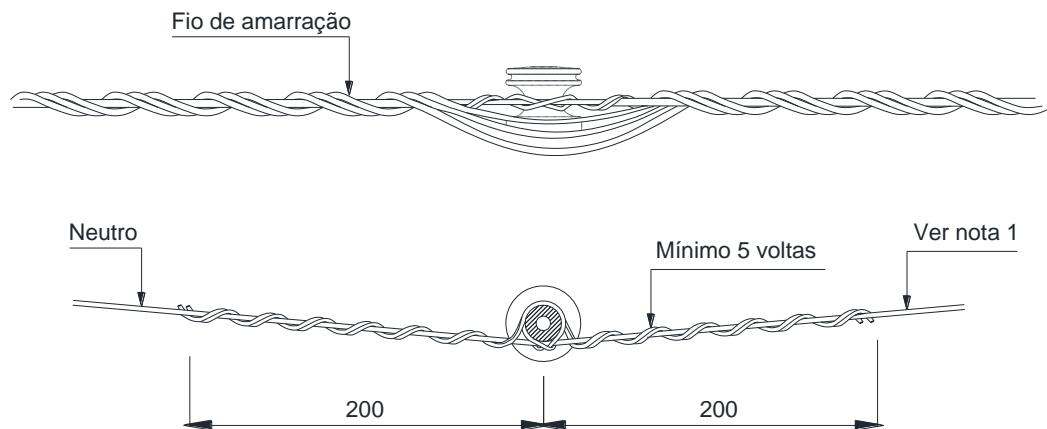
Amarragens e ligações – Estrutura secundária – Tangente
